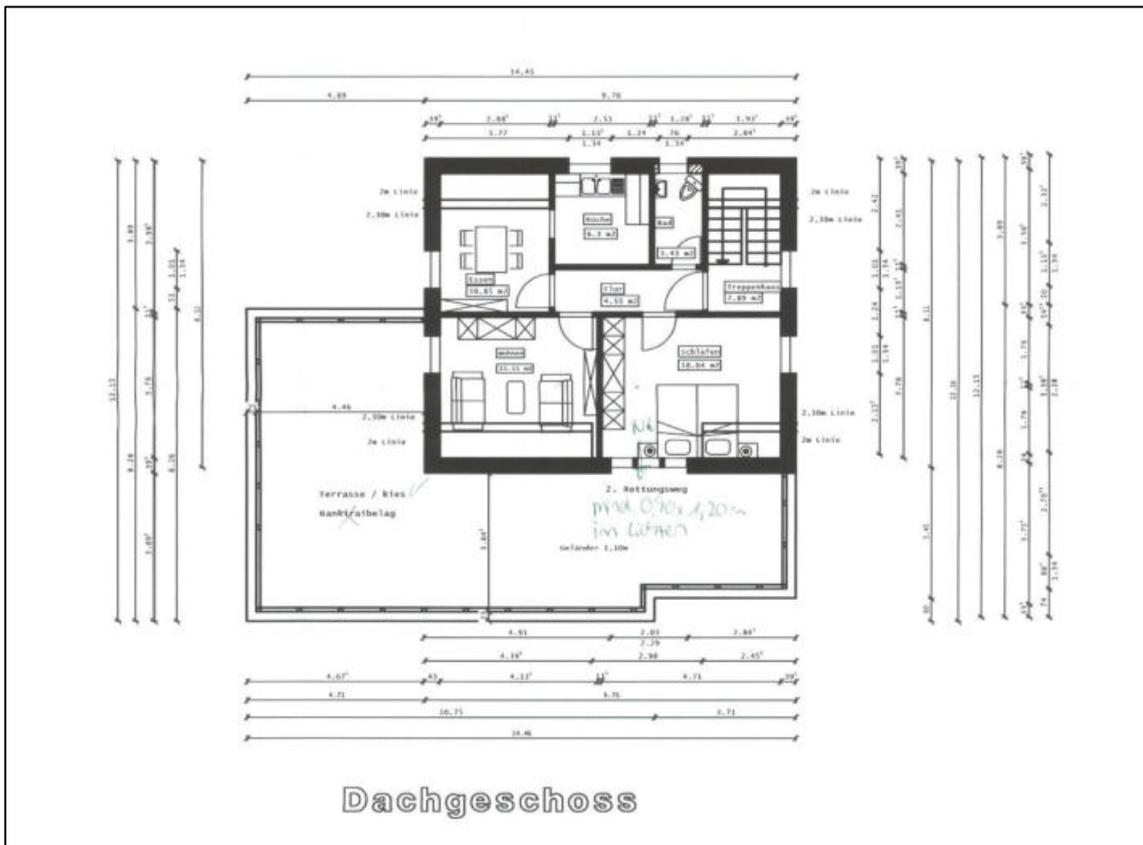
Dachgeschoss-Grundriss von dem Zweifamilienhaus
